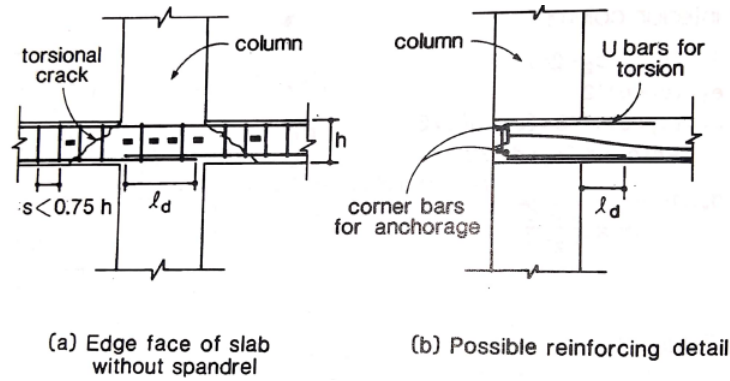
Refuerzo torsional pasivo en columna exterior de losa [18]
